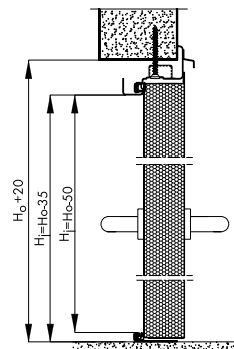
Montaža enokrilnih vrat z kotnim podbojem v jekleno okvirno konstrukcijo, horizontalni prerez.
